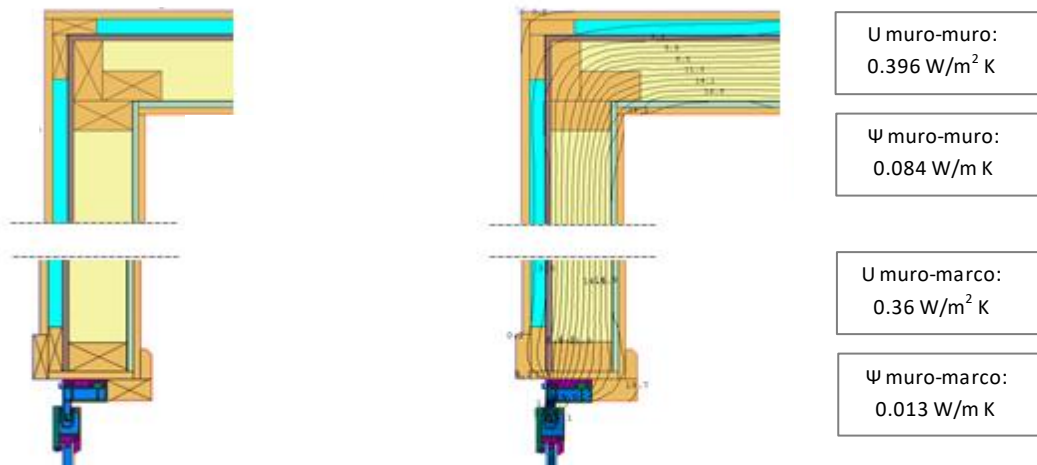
Detalle y diagrama de unión de esquina y unión muro-marco en vista de planta, tabiquería 2"x4"
